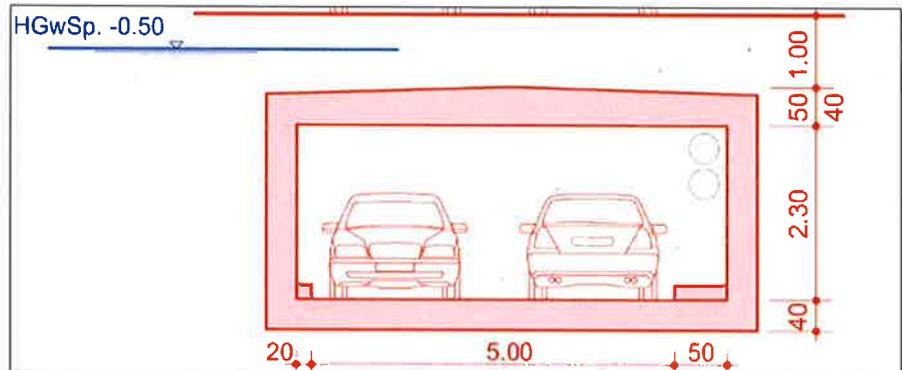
Querschnitt geplante unterirdische Erschliessungsstrasse, Quelle dsp Ingenieure + Partner AG, Stand: 06.01.2022
